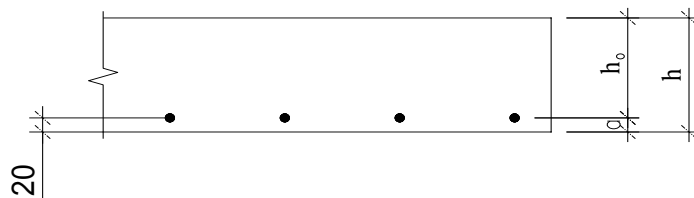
Поперечний переріз перекриття для плити П-1.
